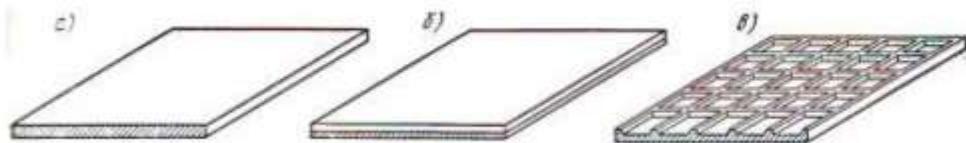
Сборные железобетонные панели перекрытий: а) сплошная однослочная, б) сплошная двухслойная, в) часторебристая с ребрами вверх
